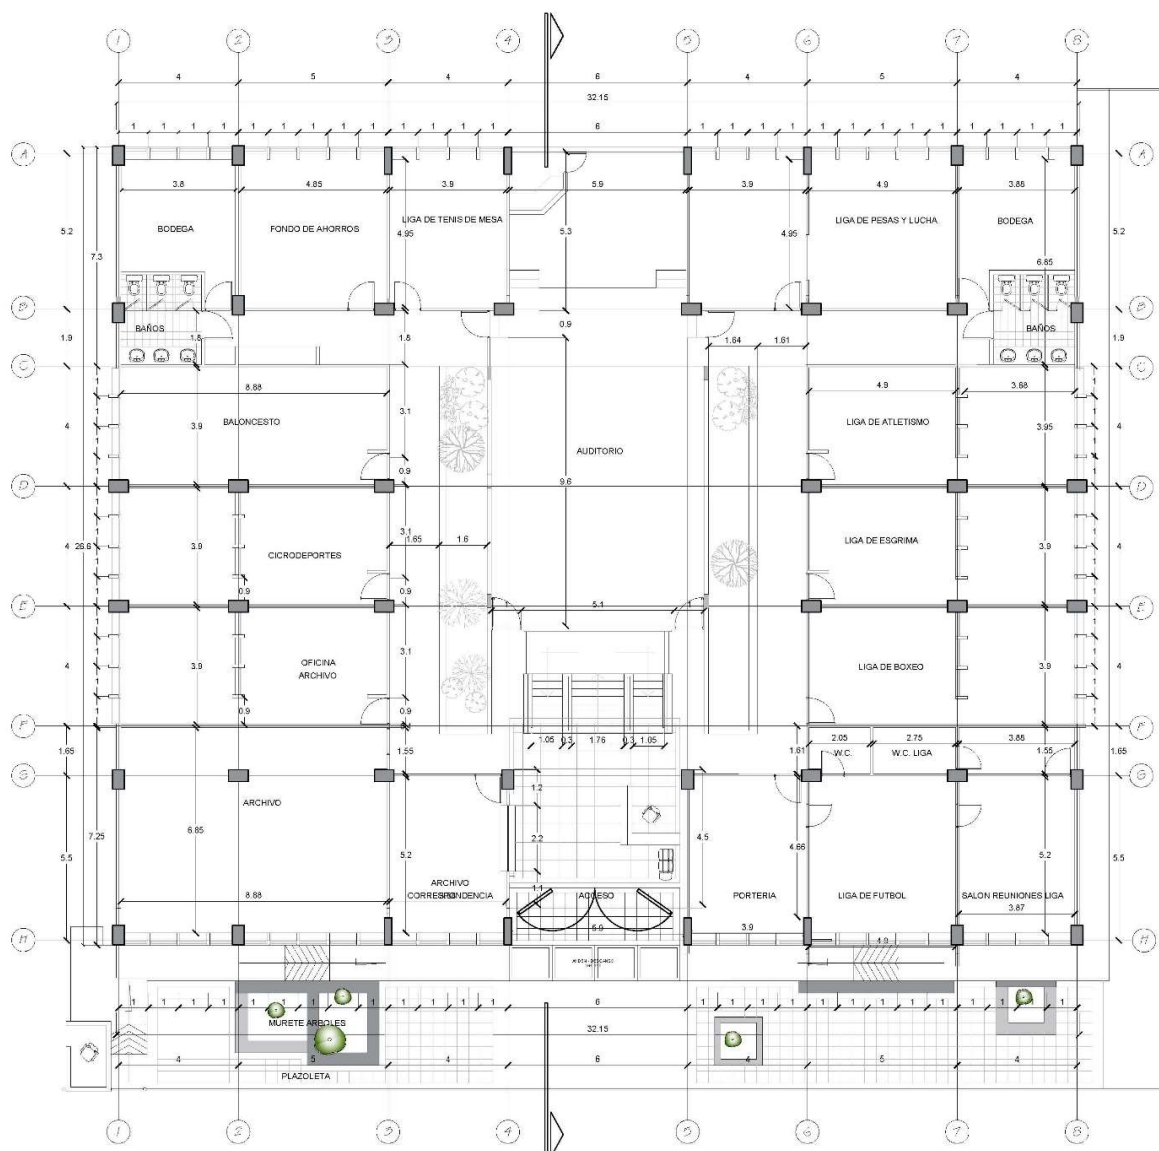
Planos Arquitectónicos – Planta 1er piso.
